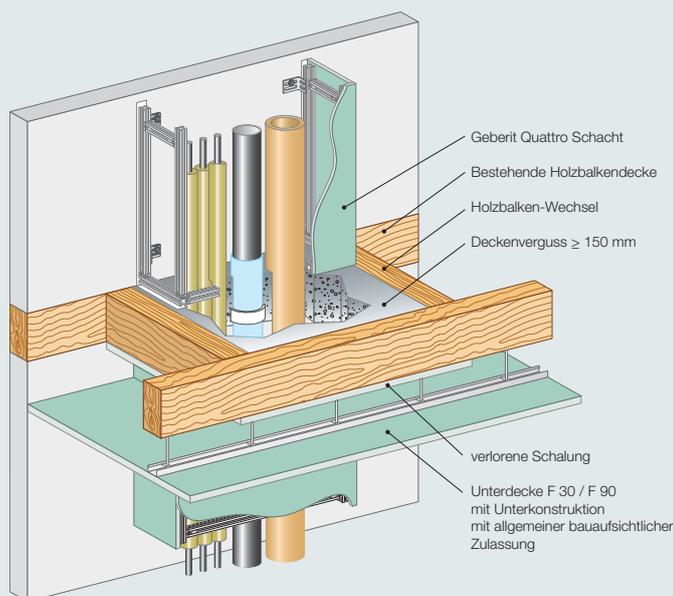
Geberit Quattro Komplettsystem in Verbindung mit Holzbalkendecken mit / ohne F 30 / F 90 Unterdecke
